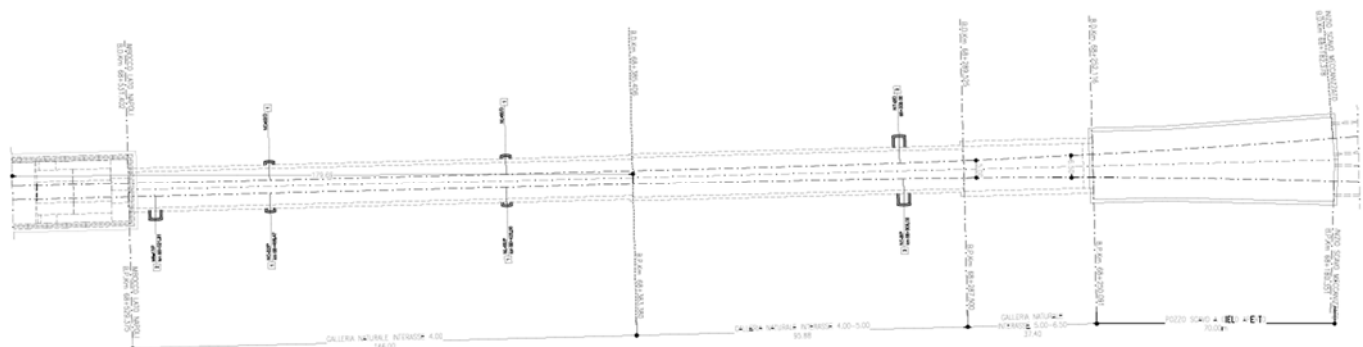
Planimetria inquadramento e poizione nicchie - imbocco lato Napoli (pk 68+250.091 – 68+529.375 BP)
